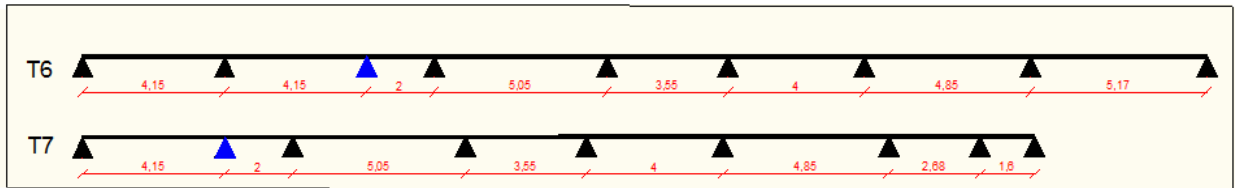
schéma statique des poutrelles de la terrasse accessible.
